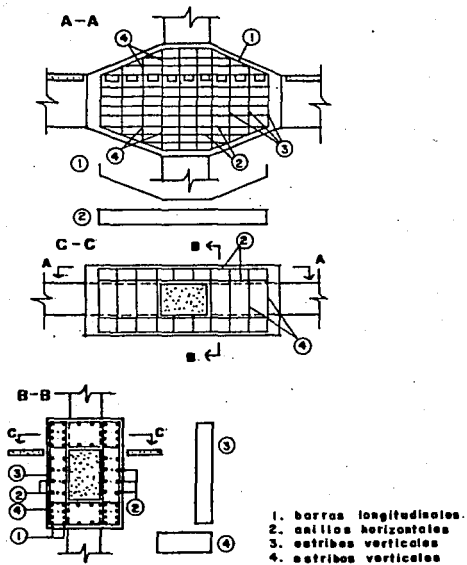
Encamisado local de un nudo con concreto reforzado (Ref. 15)
